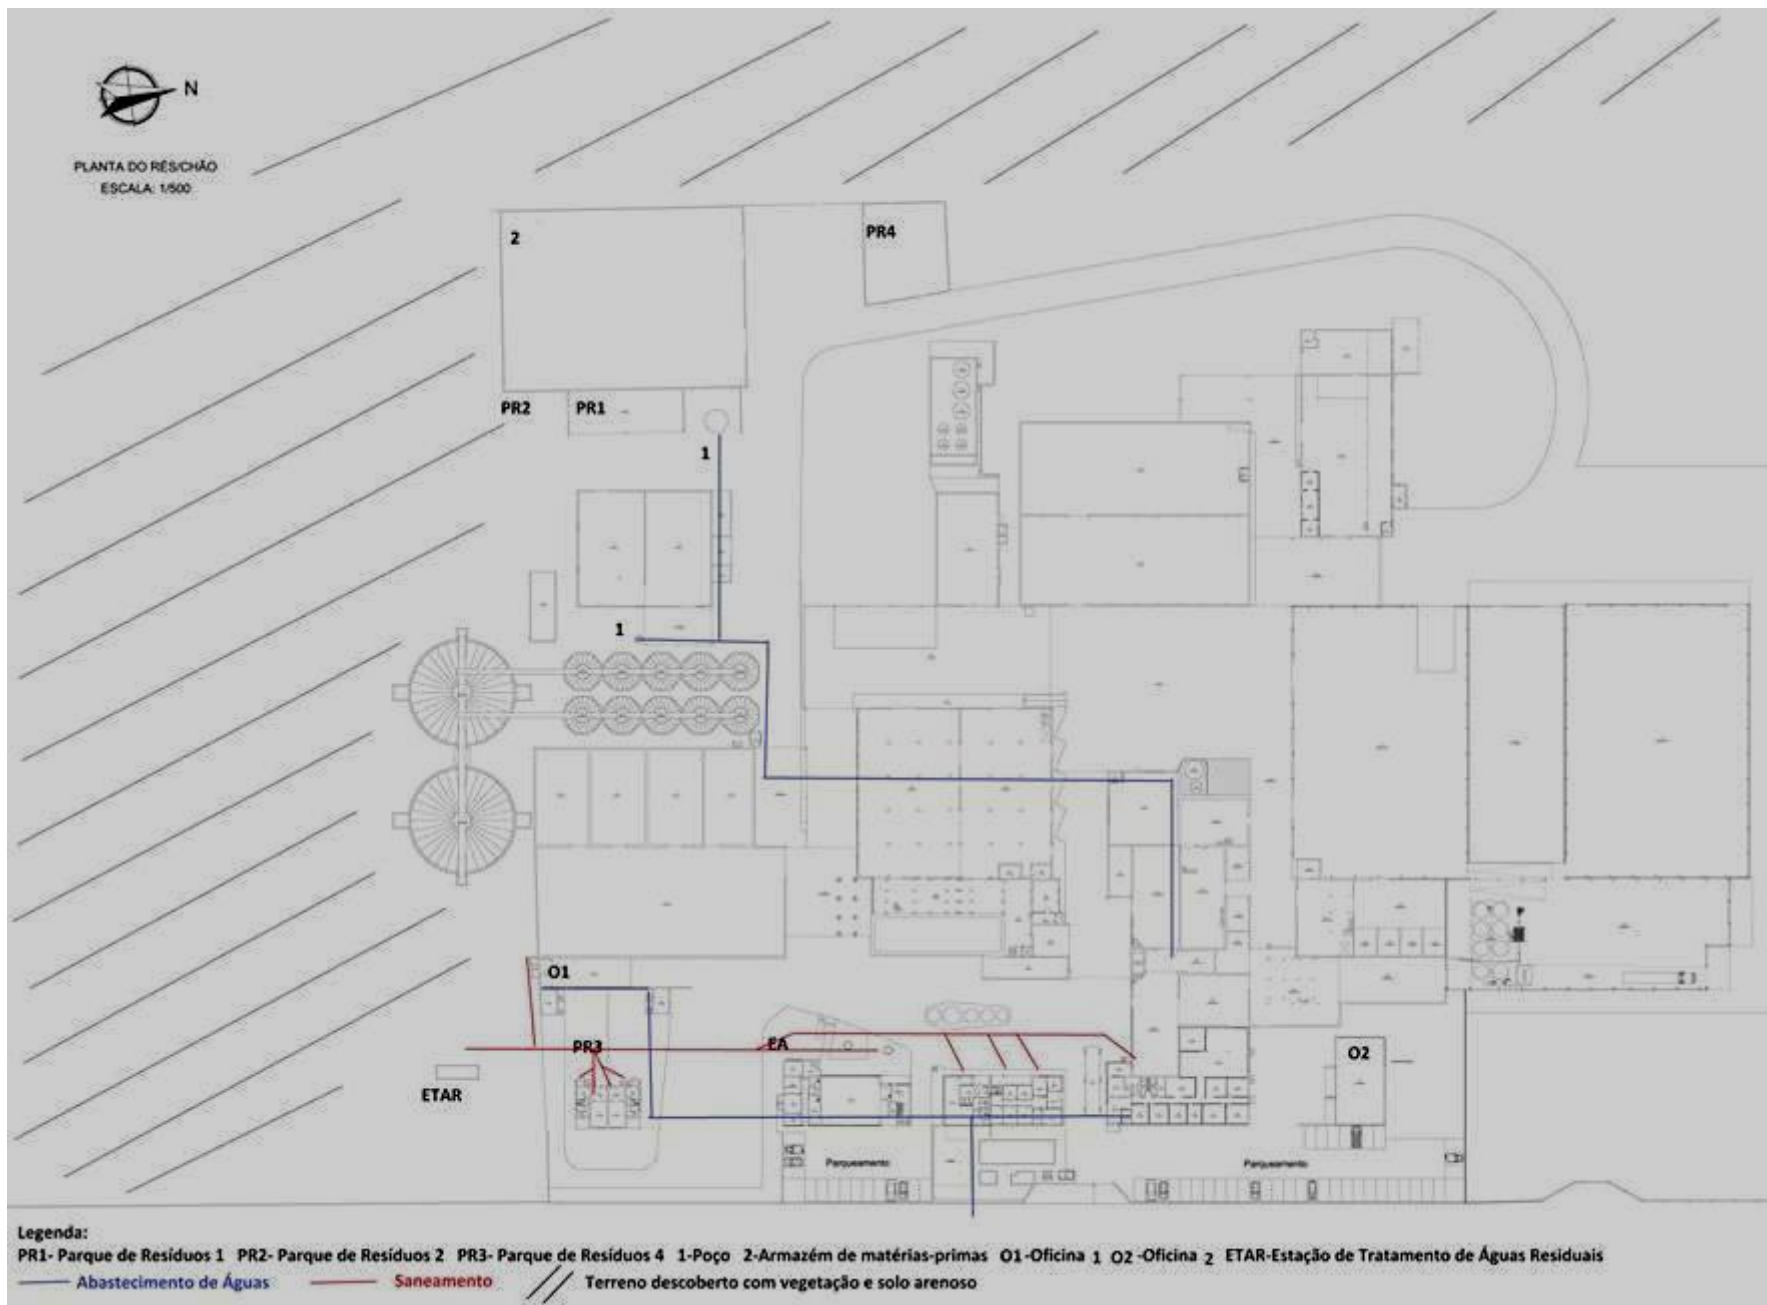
Planta do Rés-do-chão da Instalação em estudo.
